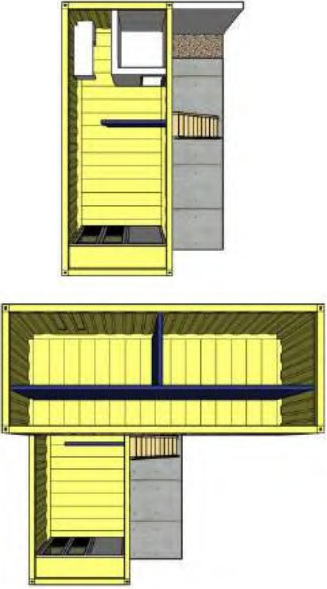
71 Ilustrasi Denah *Open Plan
